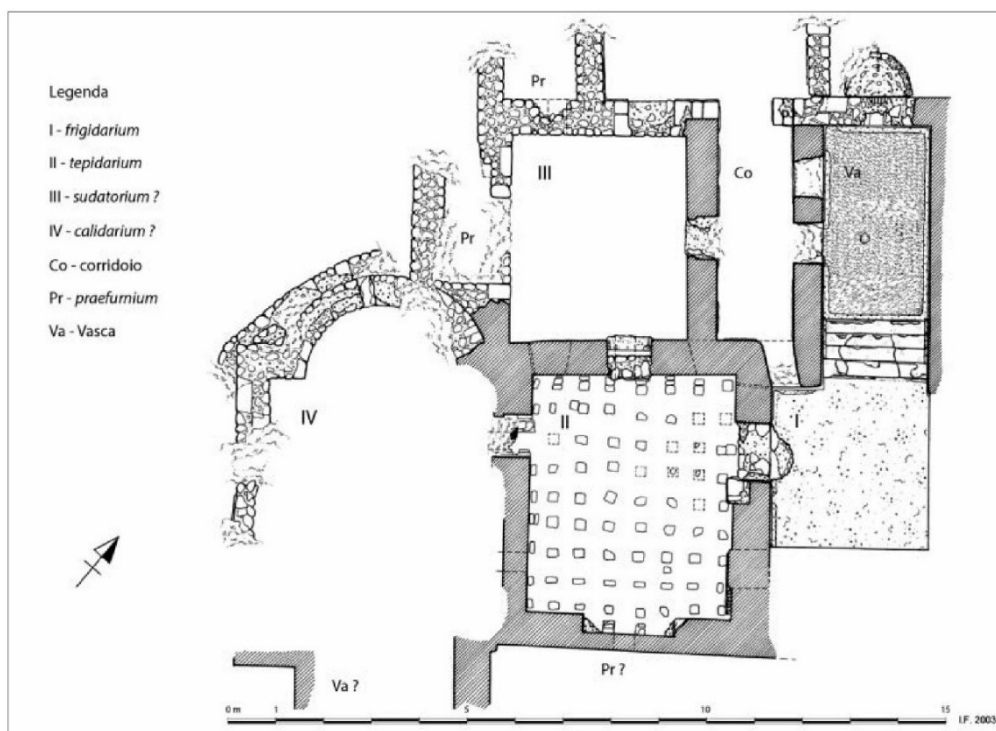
Planimetria del complesso termale in località Malvindi (Ferrari 2017, p. 69, Tav. 1)
